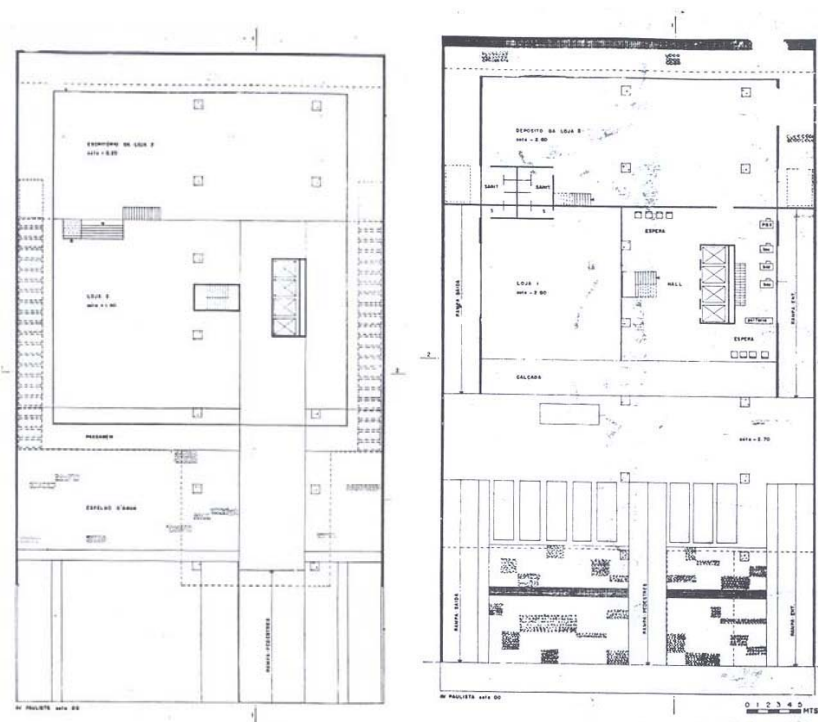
Plantas pavimento térreo e mezanino - Fonte: ACROPOLE, nº 255 jan.,1960, p. 89.
